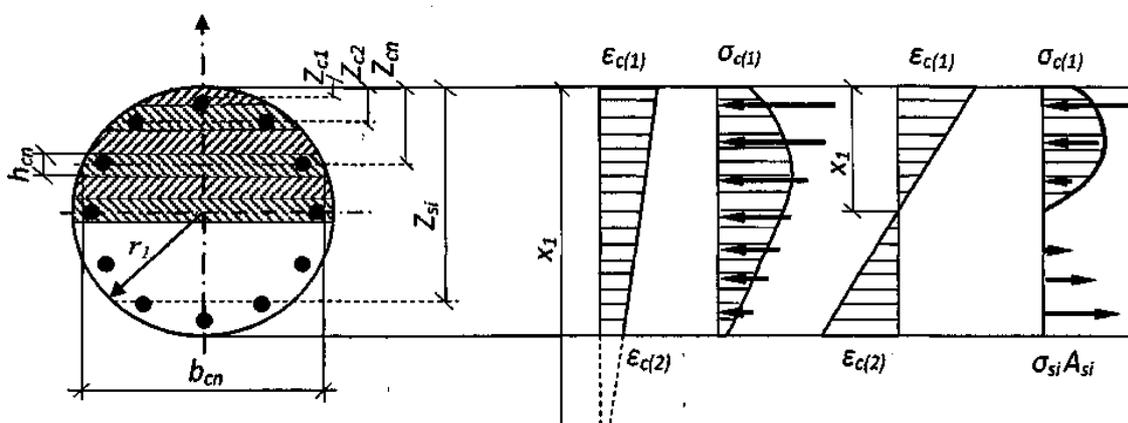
Разбиение сжатой зоны железобетонного элемента кругового сечения на m слоев, перпендикулярных оси действия момента [6]
